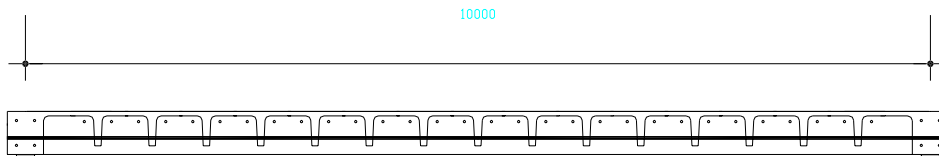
Solution 10m - BFUP précontraint avec joints longitudinaux - Coupe longitudinale avec élévation du câblage et vue de la précontrainte transversale.
